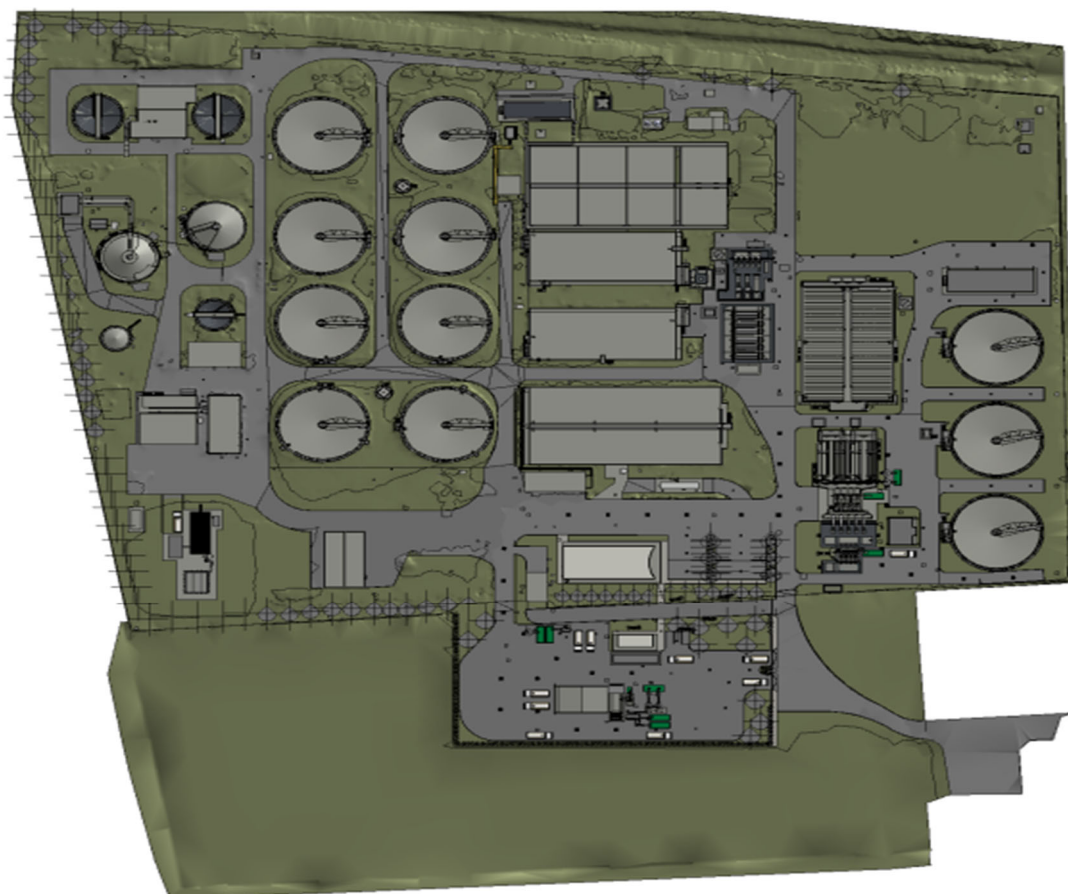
Layout stato di progetto impianto di depurazione di Ravenna
